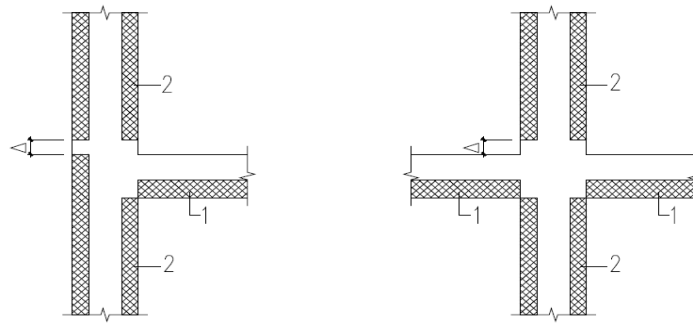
边缘构件预制墙板悬挑段与后浇混凝土构造示意
